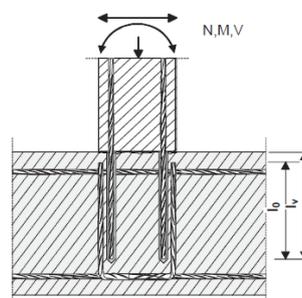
Jonction par recouvrement d'armatures pour la liaison d'un poteau ou d'un mur sur une fondation avec armatures en traction, d'après le DEE 330087-02-0601 [1]
